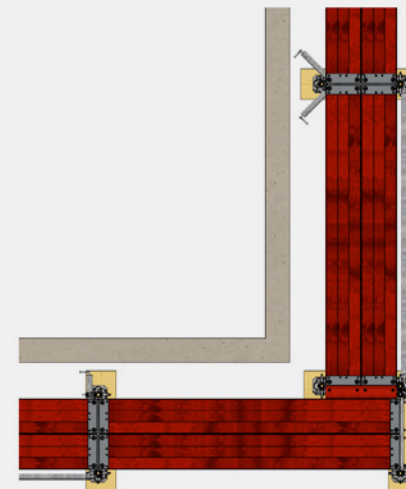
Анкерные крепления в углах, исполнение с двумя вертикальными рамами
